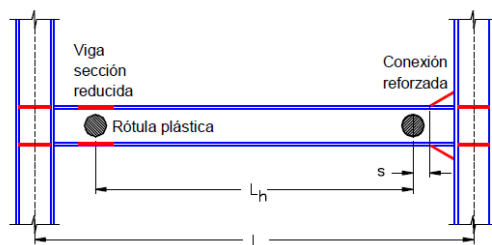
Localización “deseada” de rótulas plásticas en vigas de edificios aporticados a momento.
